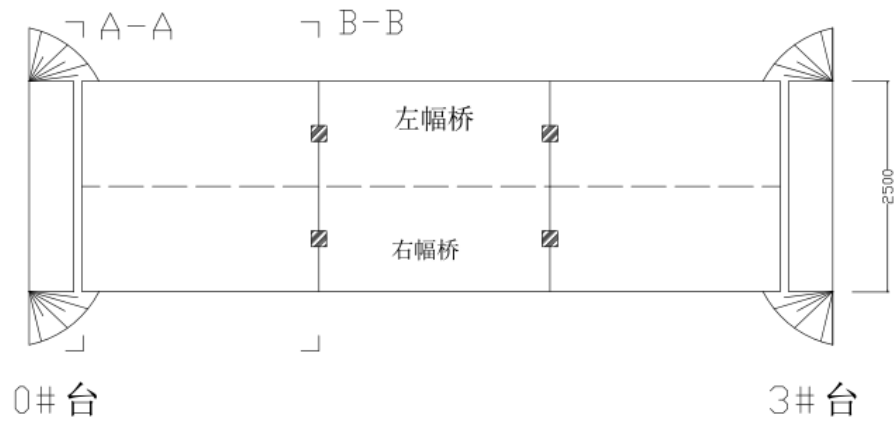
青年路立交桥平面布置图（单位 cm）
